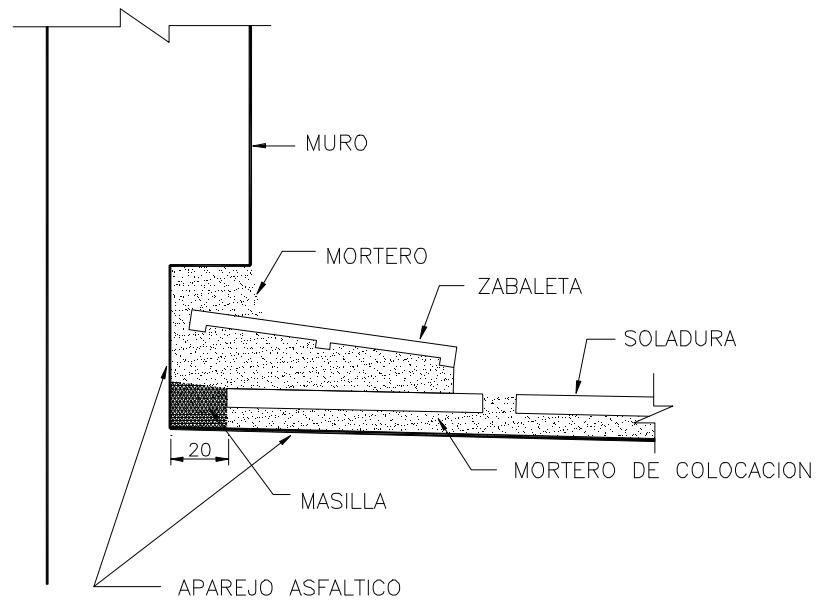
CONSTRUCCION DE MAESTRA JUNTO A UN MURO
